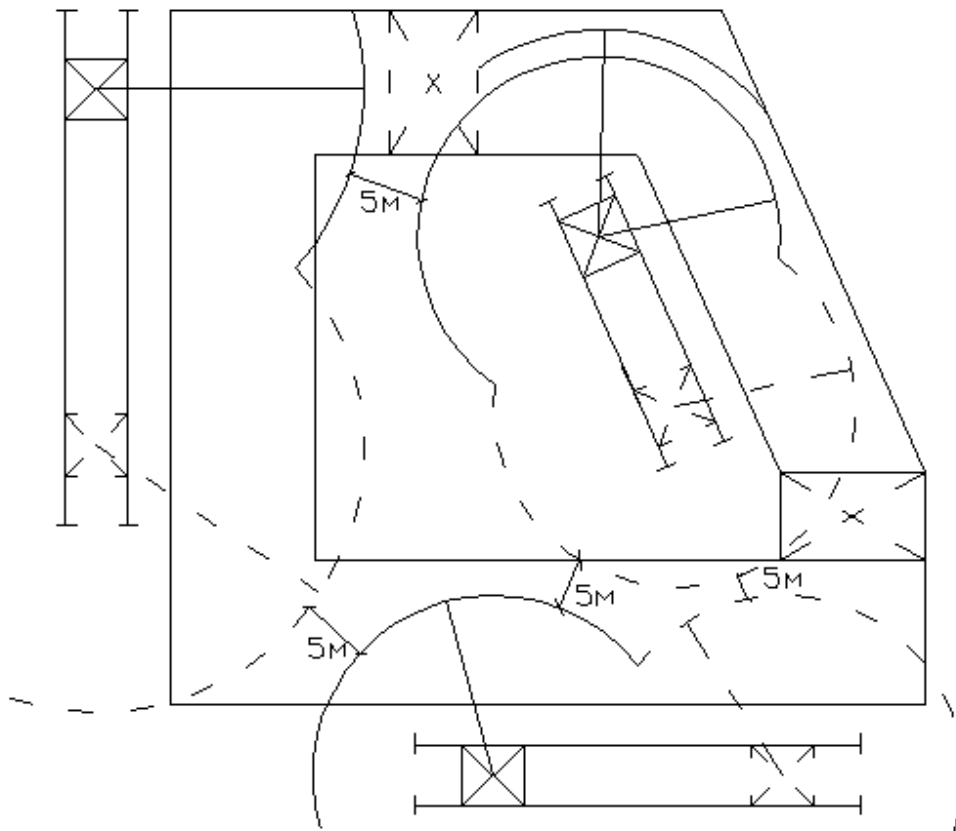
Три крана установлены у флигелей ремонтируемого здания (два лицевых и дворовой)
